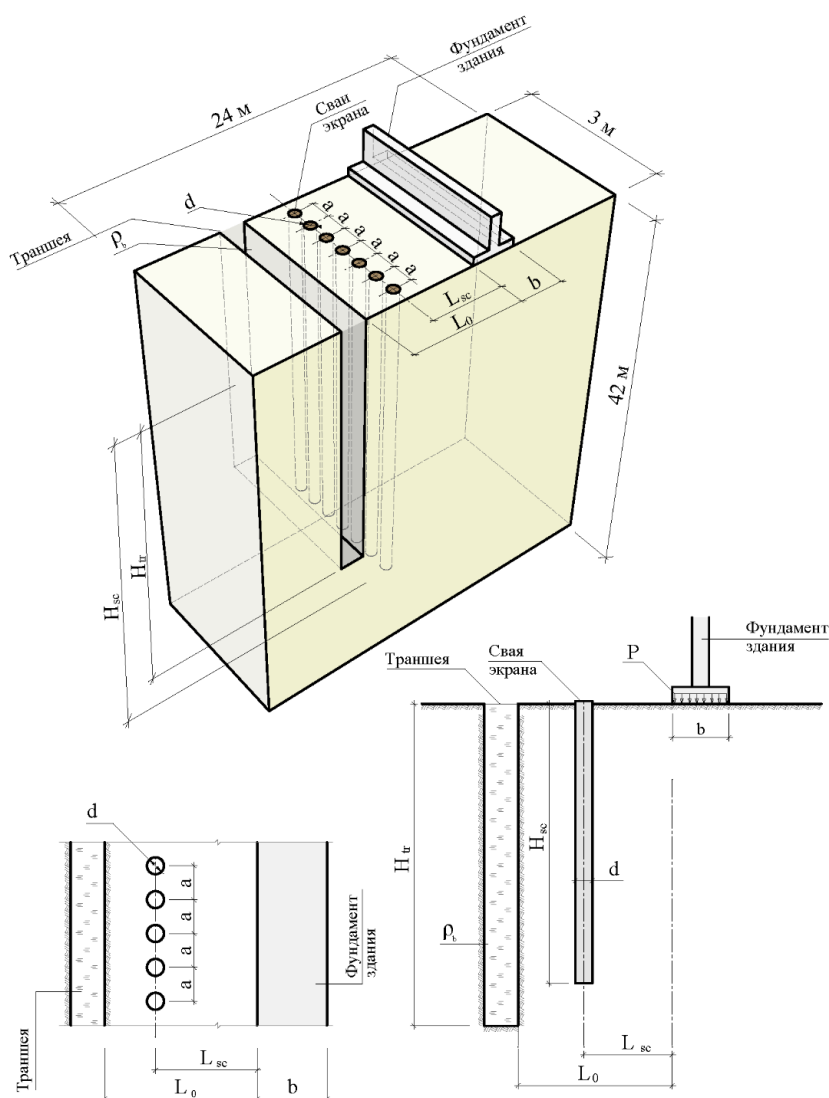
Расчетная схема к задаче о влиянии применения геотехнического экрана из разреженного ряда свай, на осадки рядом расположенного здания, вызванные разработкой траншеи
